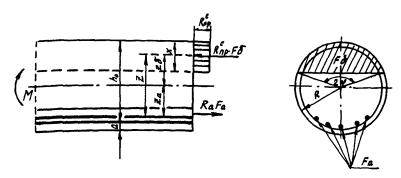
Схема расположения усилий и эпиранапряжений в поперечном сечении изгибаемого элемента с одиночной арматурой.
